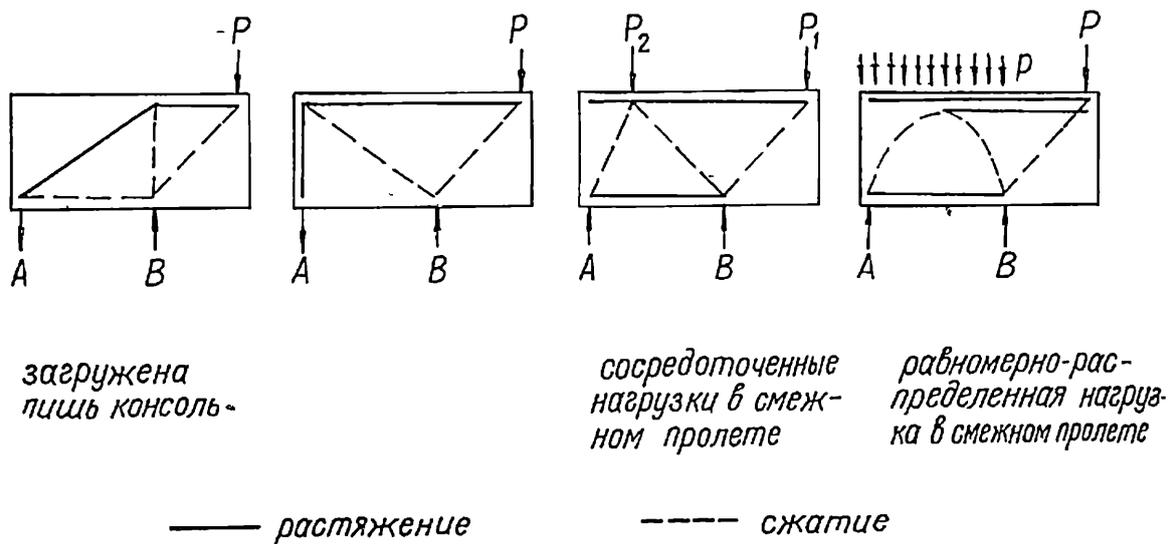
10. Схематическое распределение усилий в консольных балках-стенках
